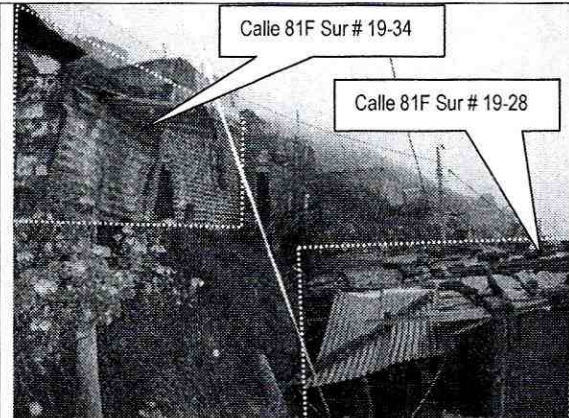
Vista de los predios evaluados ubicados en la Calle 81F Sur # 19-34 y Calle 81F Sur # 19-28. Se observa la configuración de las construcciones en la ladera.
